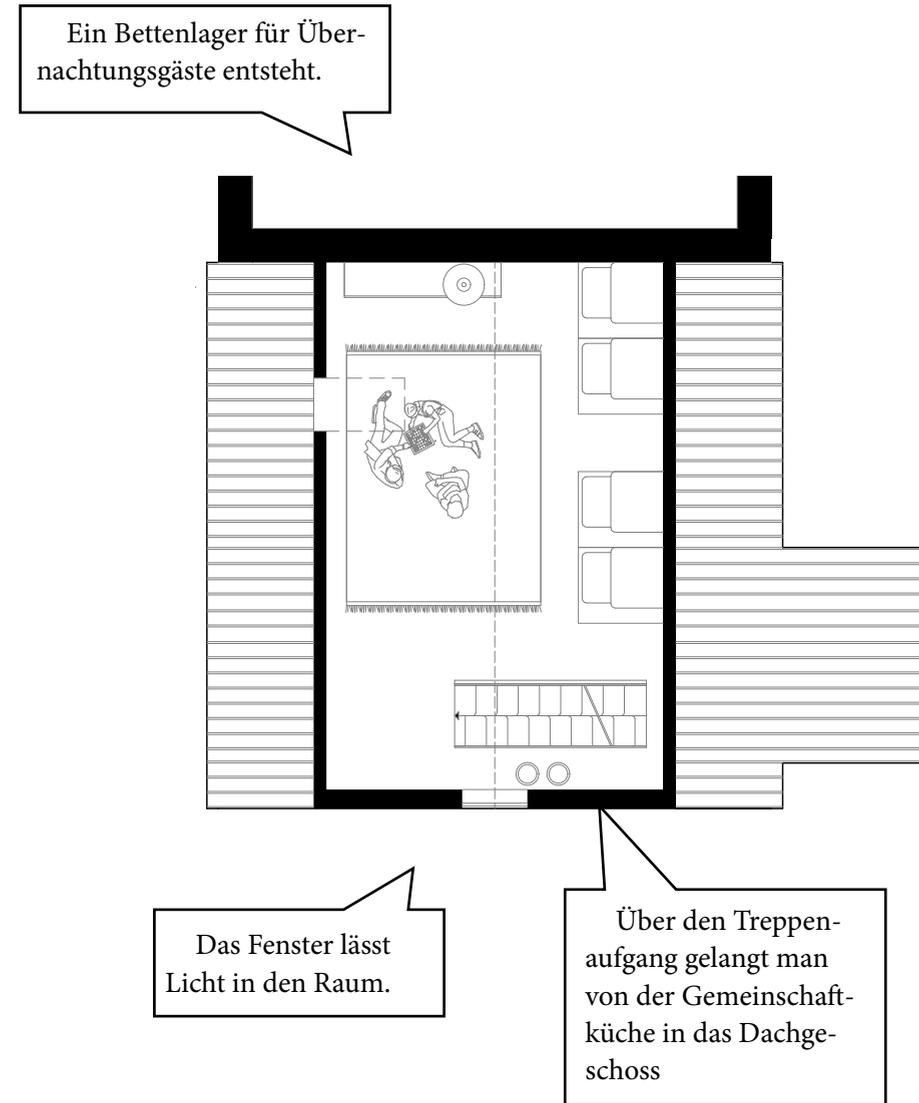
Grundriss Dachgeschoss 1:100
